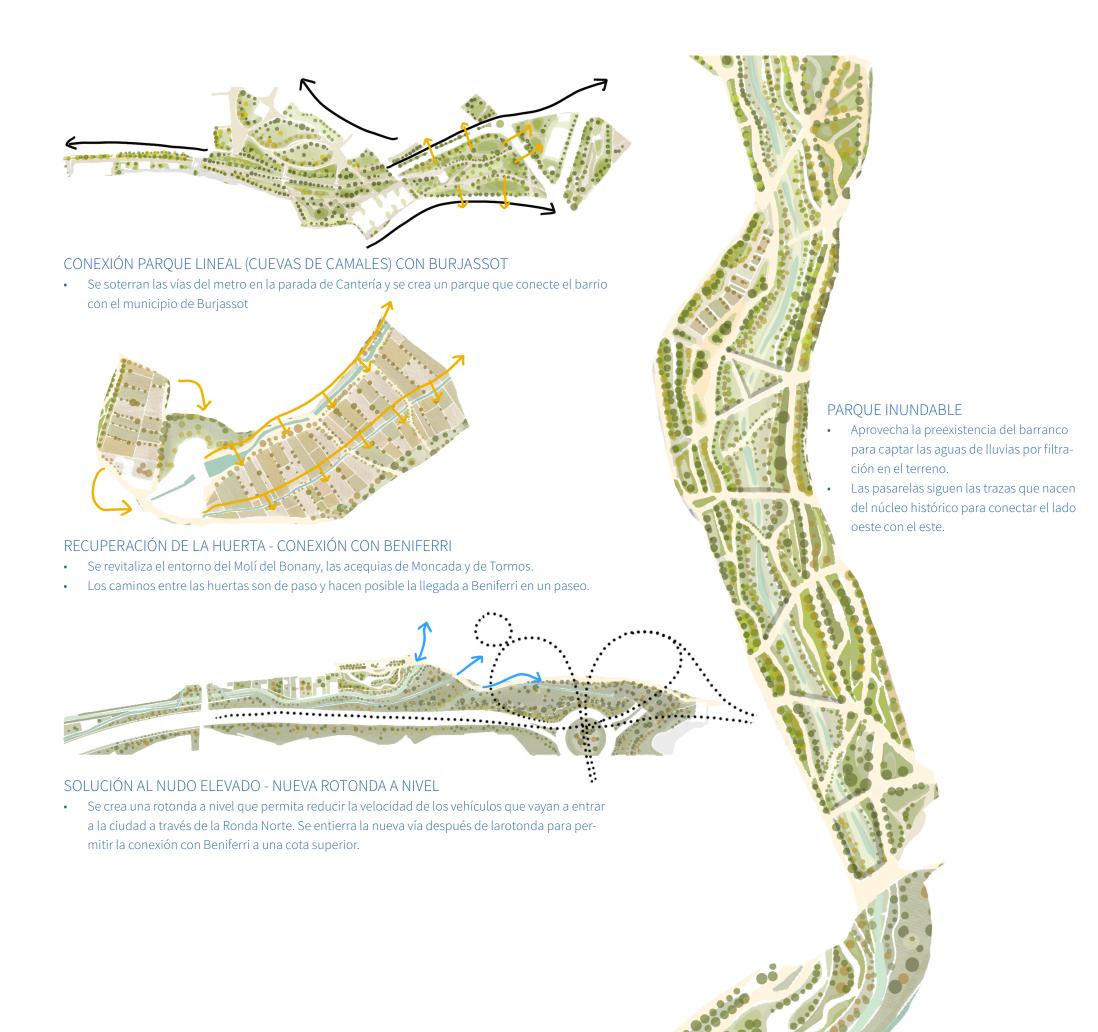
Emplazamiento de la propuesta en Planta Baja Fuente: Elaboración propia junto a Carlos Planas Estañ
